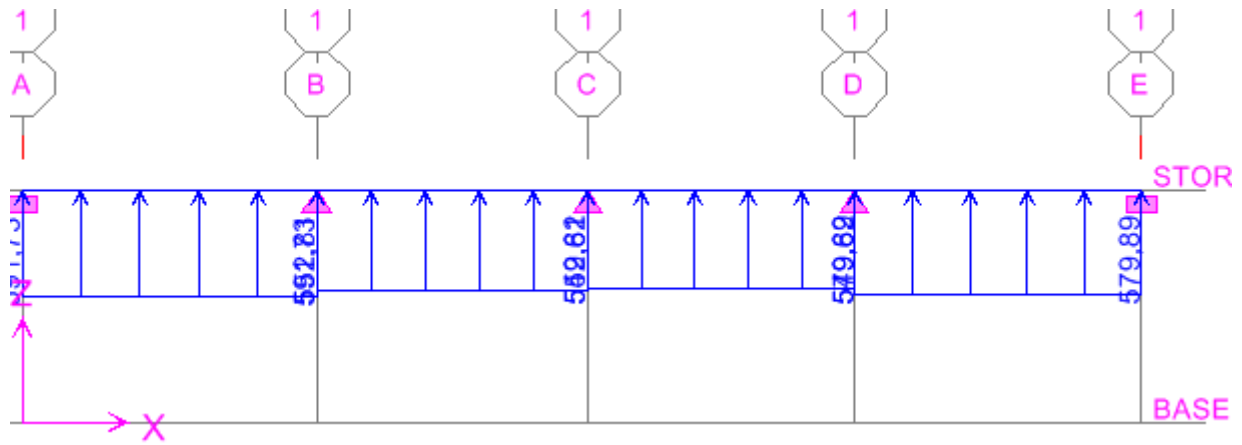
Schéma statique de la nervure ELU (sens transversal).
